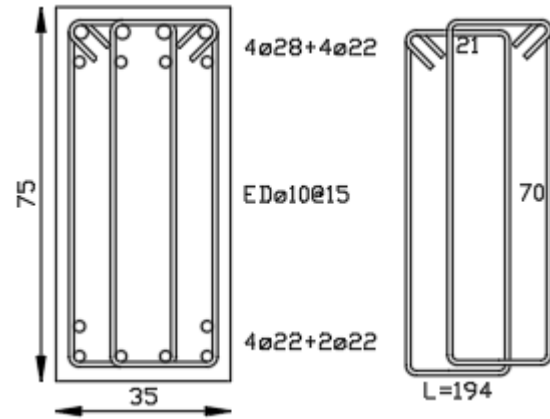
Vigas ejes A y F, nivel 1-20. Edificio de 20 pisos.
